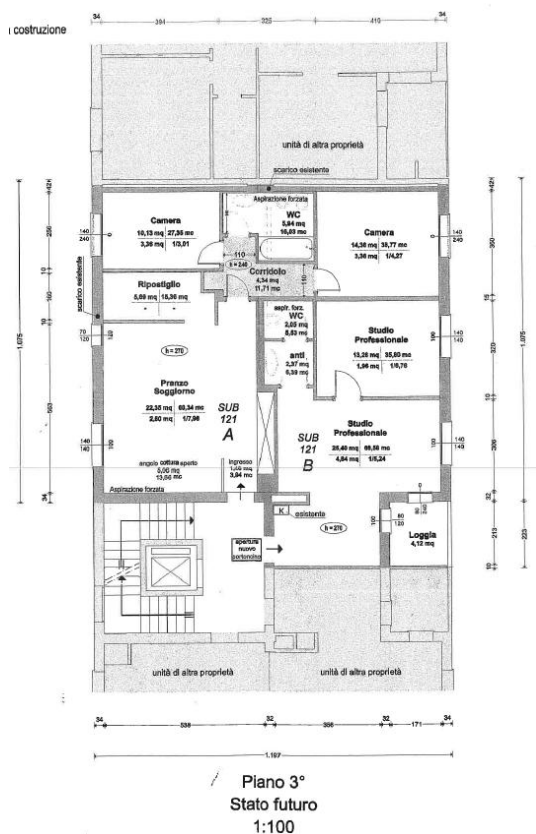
Planimetria appartamento D.I.A. N° 3387/12 in data 10/12/2012 (fuori scala)
